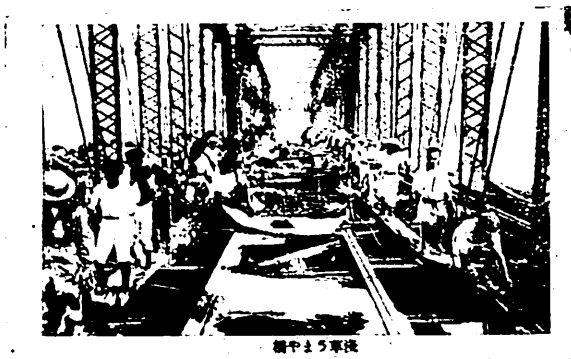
厩橋の火害／土木学会HP戦前土木絵葉書
